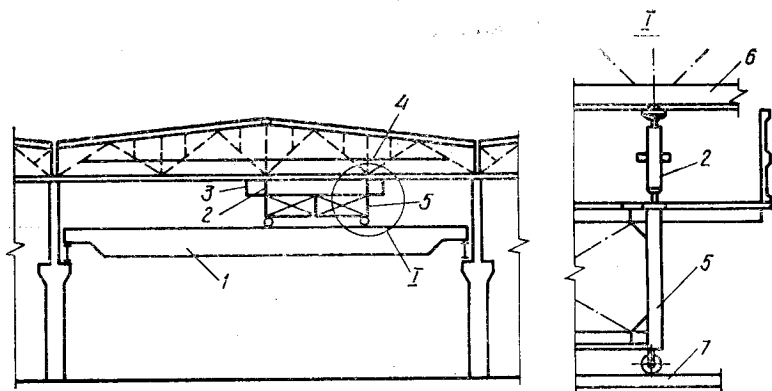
Схема мостового крана с передвижной площадкой-опорой, применяемого для работ по усилению стропильных ферм:
